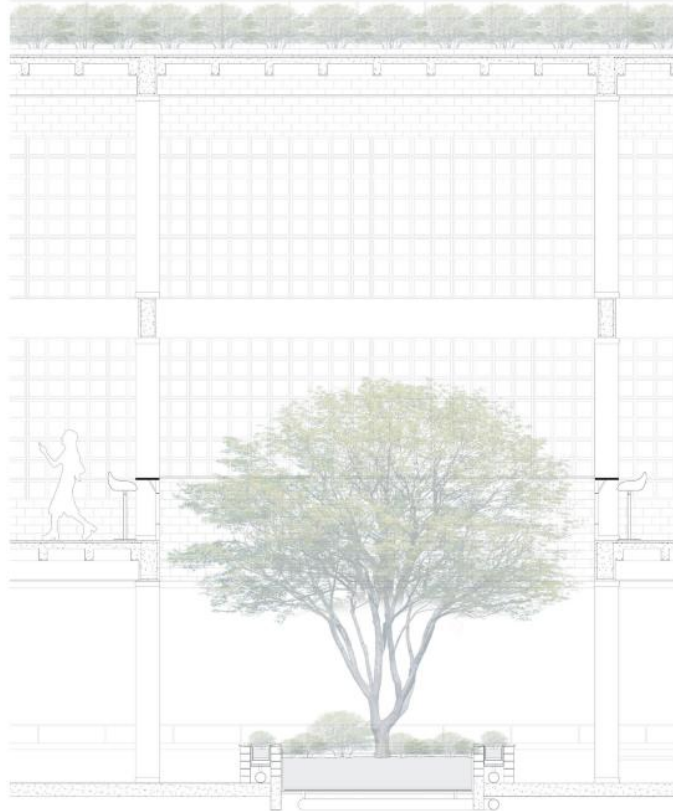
Corte transversal C-C. Por: Elaboración propia.
